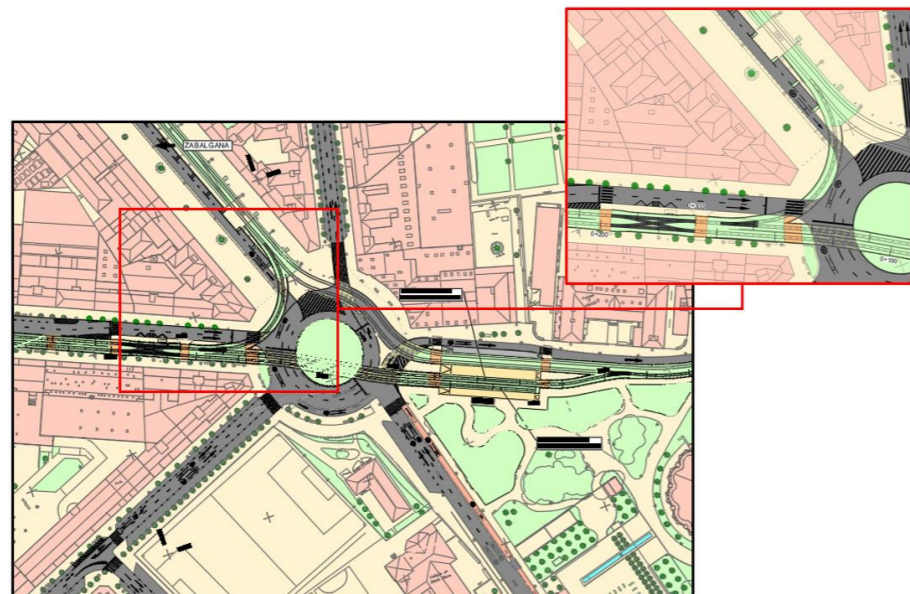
AfECCIÓN a infraestructura existente en Sancho el Sabio.
